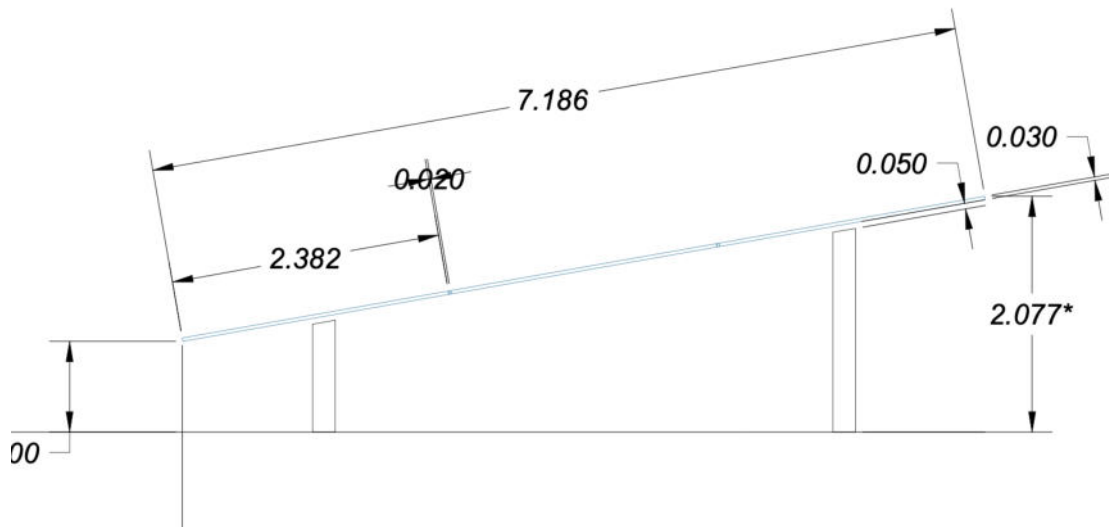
Technische Zeichnung - Quelle: Auftraggeber
